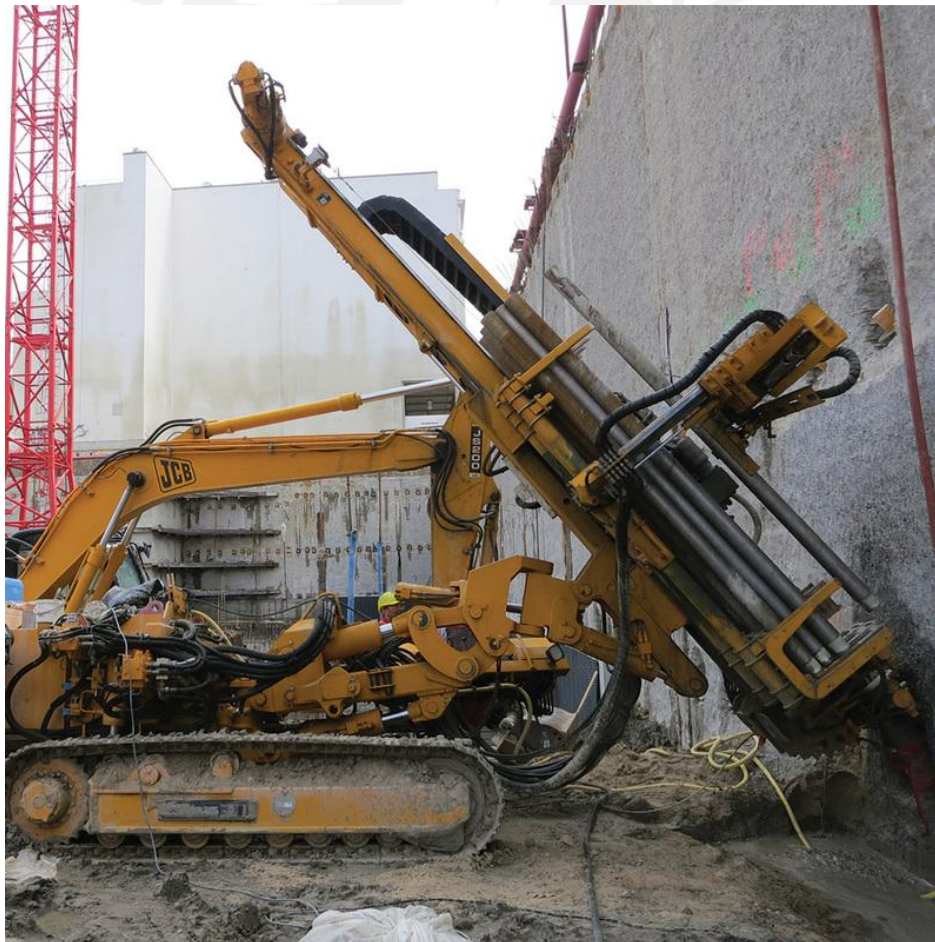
Máquina KR 805-2 (Geomek, 2015)
